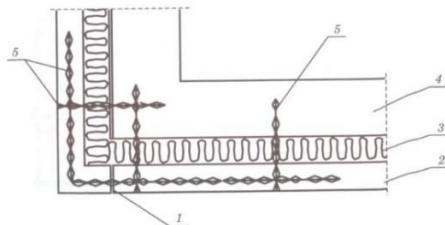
Г-образные стальные стержни с анкерными отгибами на концах для армирования угловых зон кладки
